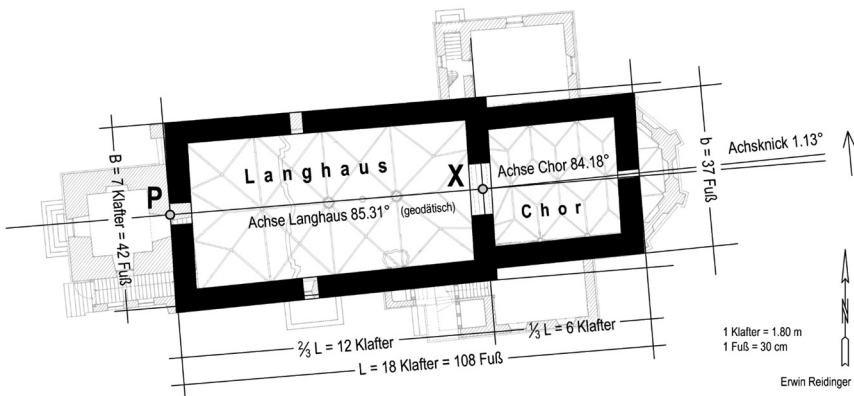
Pfarrkirche Friedberg, rekonstruierter Grundriss des romanischen Gründungsbaus (Abmessungen und Richtung)³²
